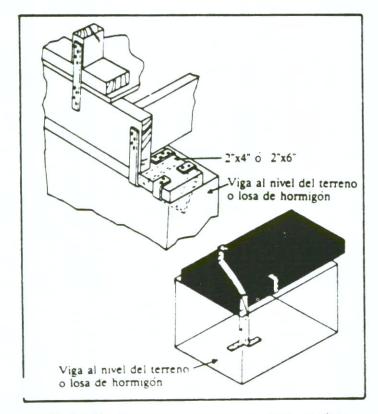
Uso de grapas o amarres para conectar una placa del fondo a un piso nuevo de hormigón
